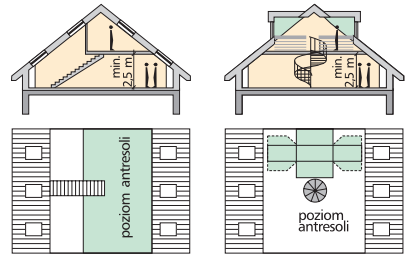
Dach dwuspadowy z oknami dachowymi.
